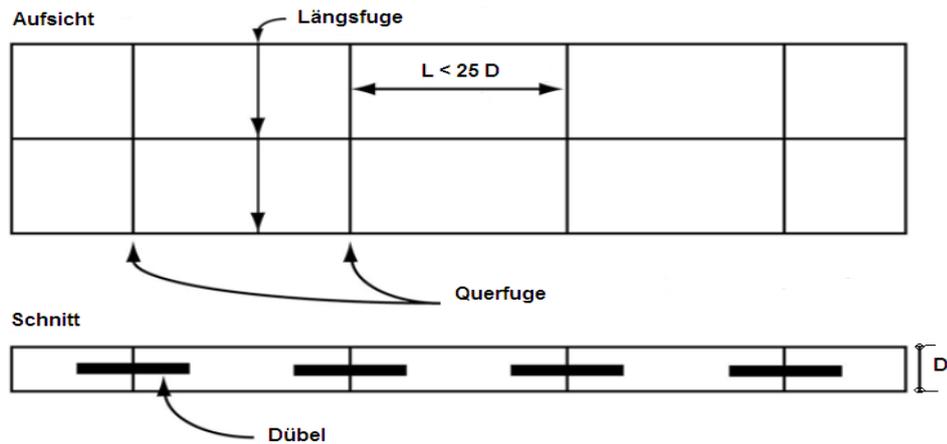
Betondecke- unbewehrt und Raumbefestigung
